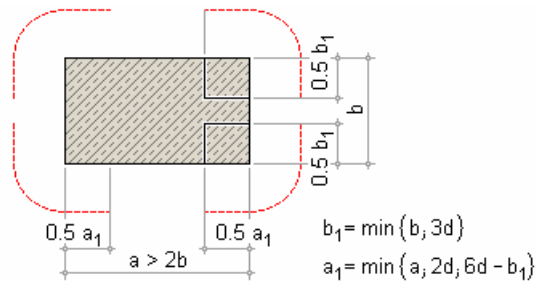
kritischer Rundschnitt bei ausgedehnten Auflagerflächen
